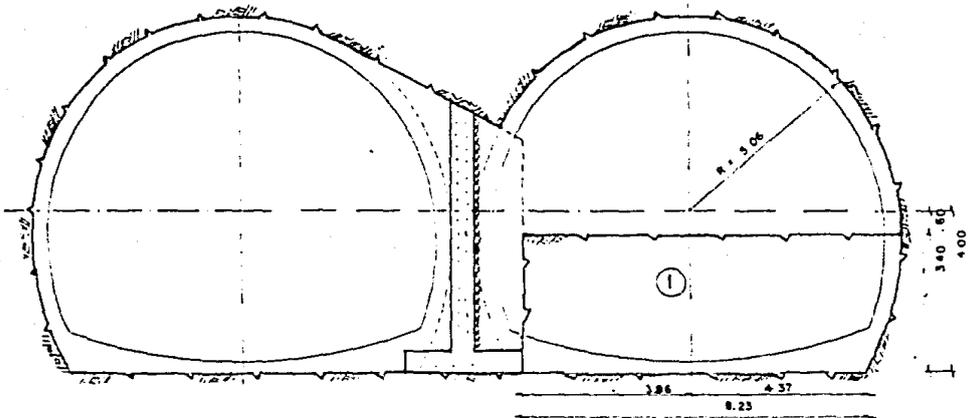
TRAMO DE TRANSICION MEDIA SECCION INFERIOR.
